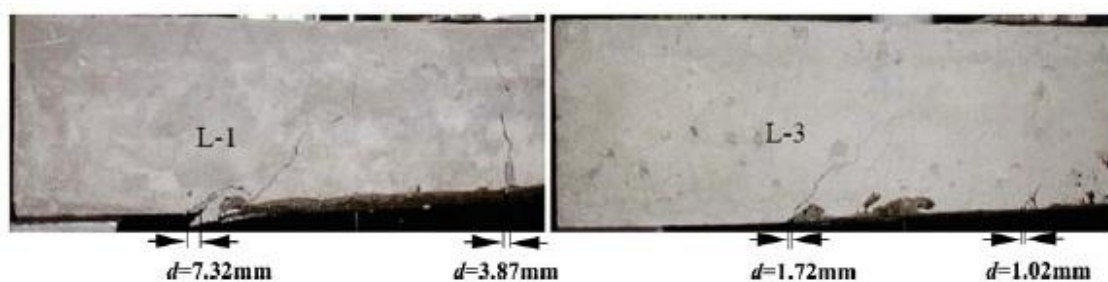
Dimensões das fendas nas vigas L-1 e L-3 após reforço com CFRP [49]
